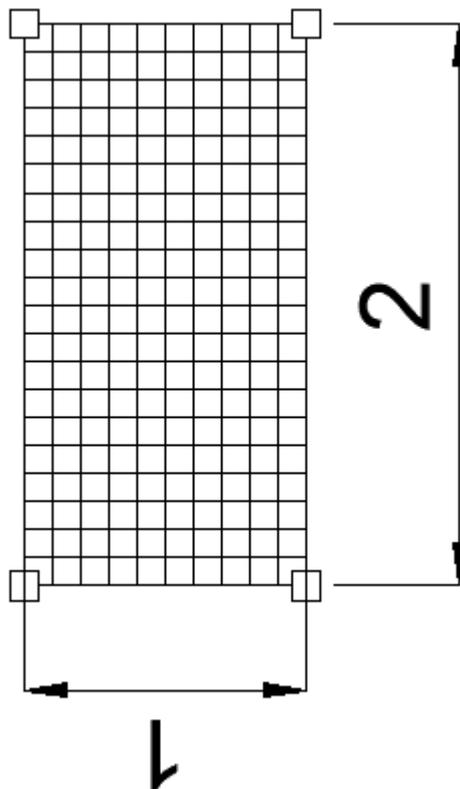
Planta baixa do secador de tipo estufa para plantas medicinais.
